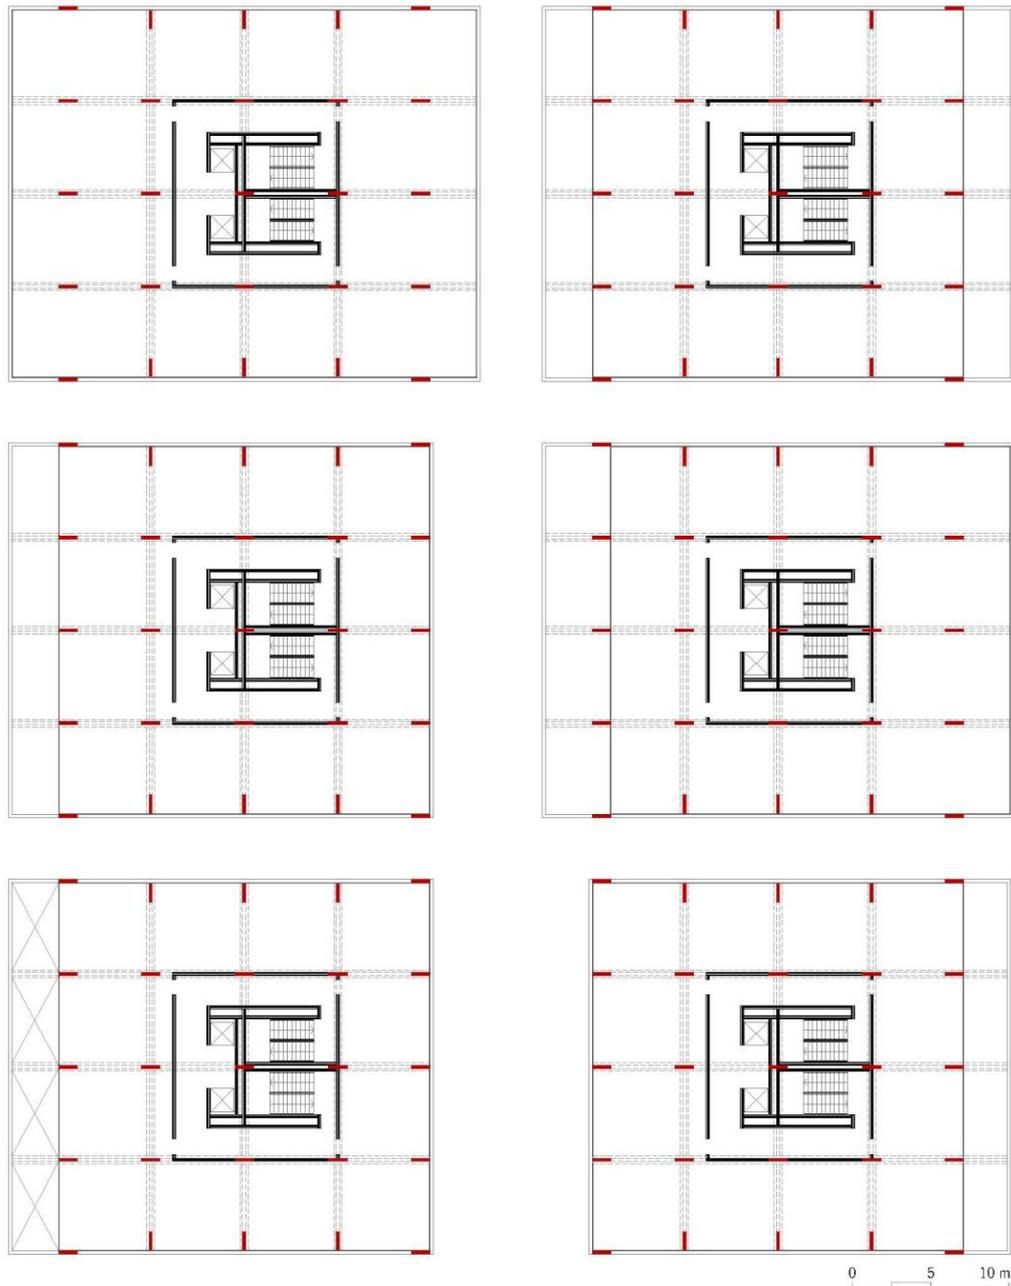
Esquema de Movimento dos Diferentes Tipos de Planta Possíveis
